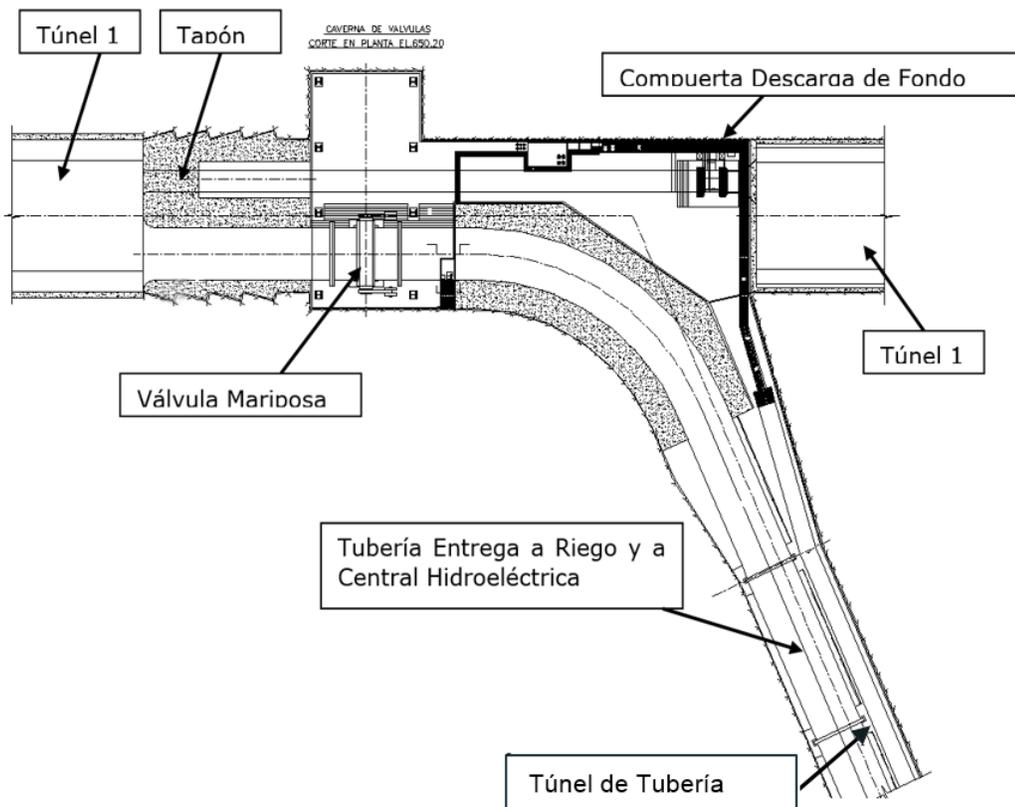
Vista en planta de zona del tapón de hormigón y caverna de válvulas. Fuente: Astaldi (2015).
